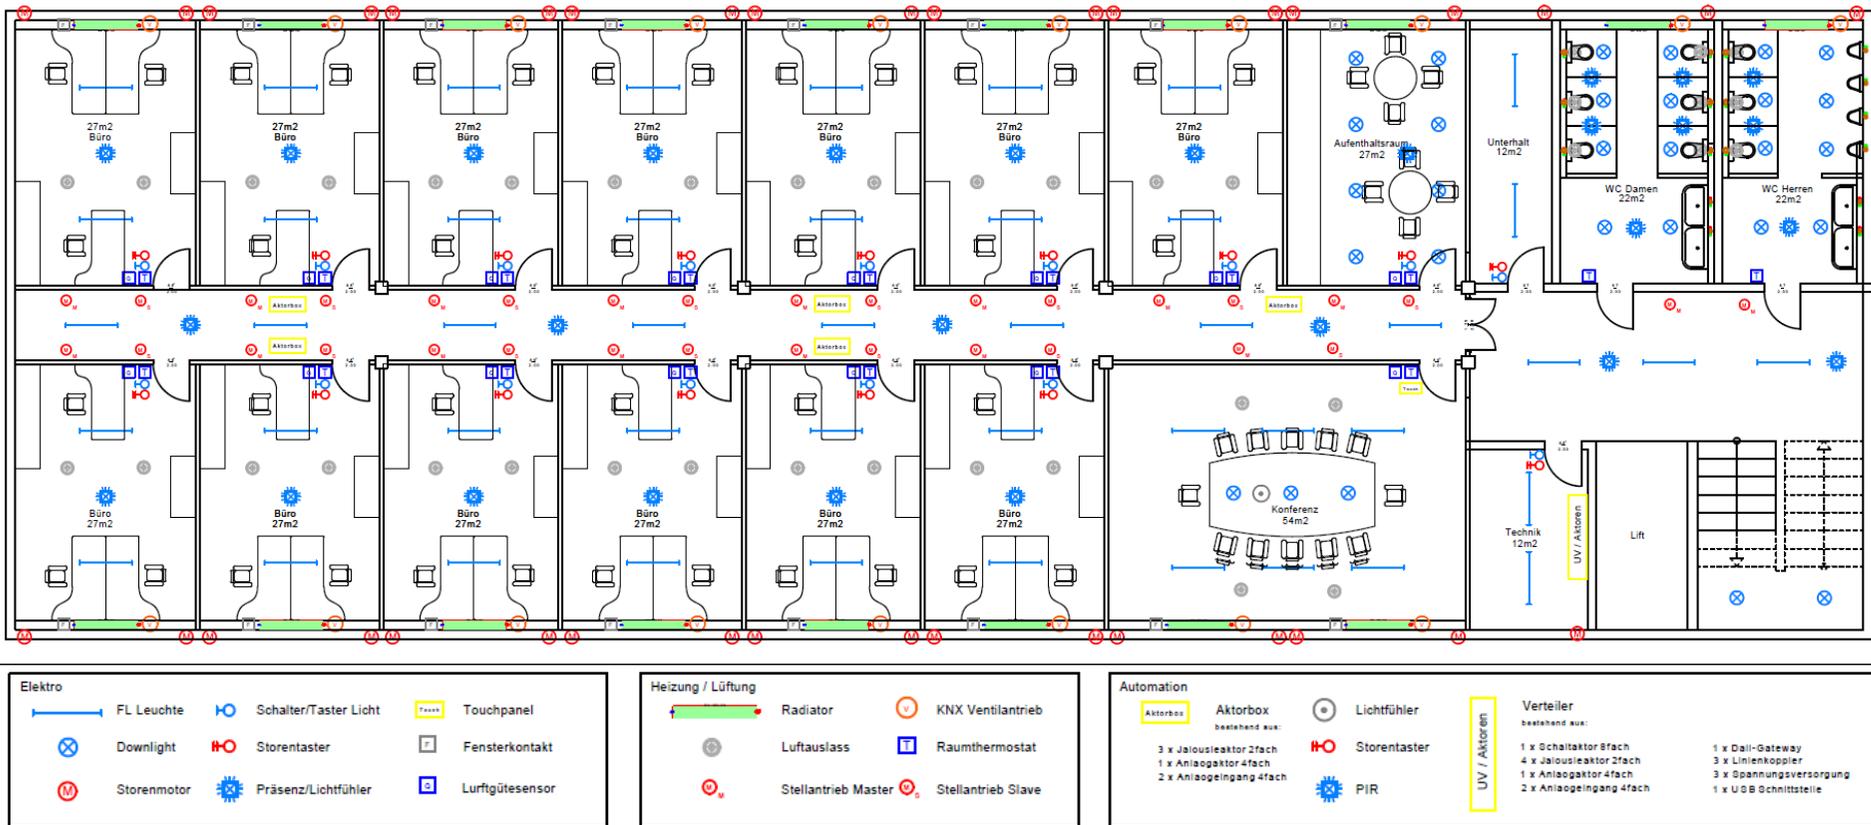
Grundriss eines Stockwerks des fiktives Bürogebäudes (Objekt 7)
